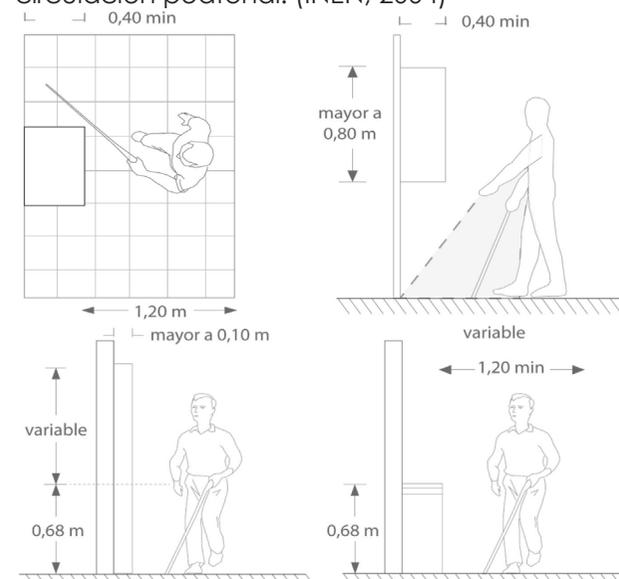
DIMENSIONES DE ELEMENTOS QUE SOBRESALEN
